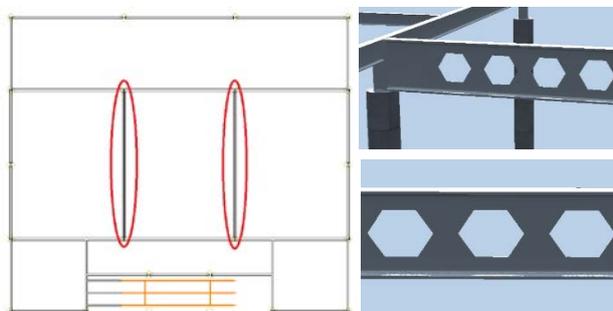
Localización de las vigas alveolares de Planta Baja y animación de las mismas. (Elaboración propia, Allplan 2015).
